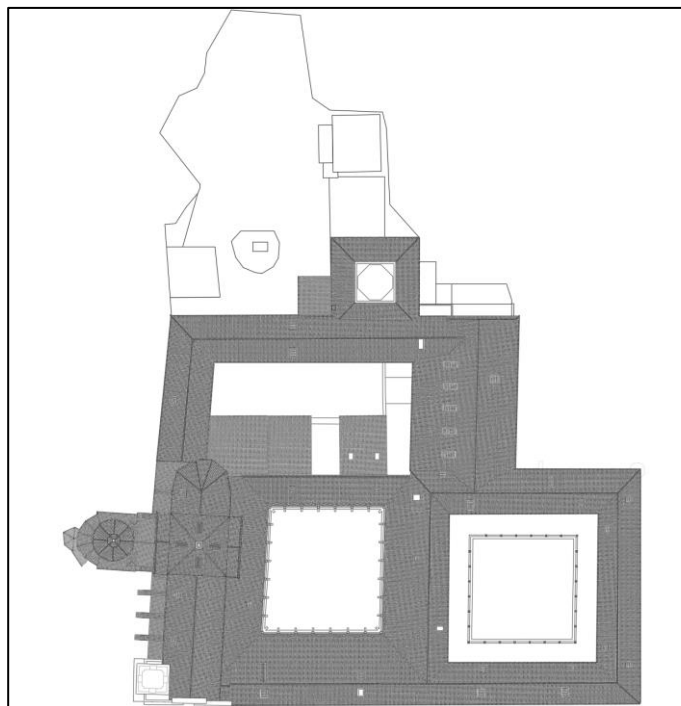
Plano de planta cubierta del Colegio BIC.
